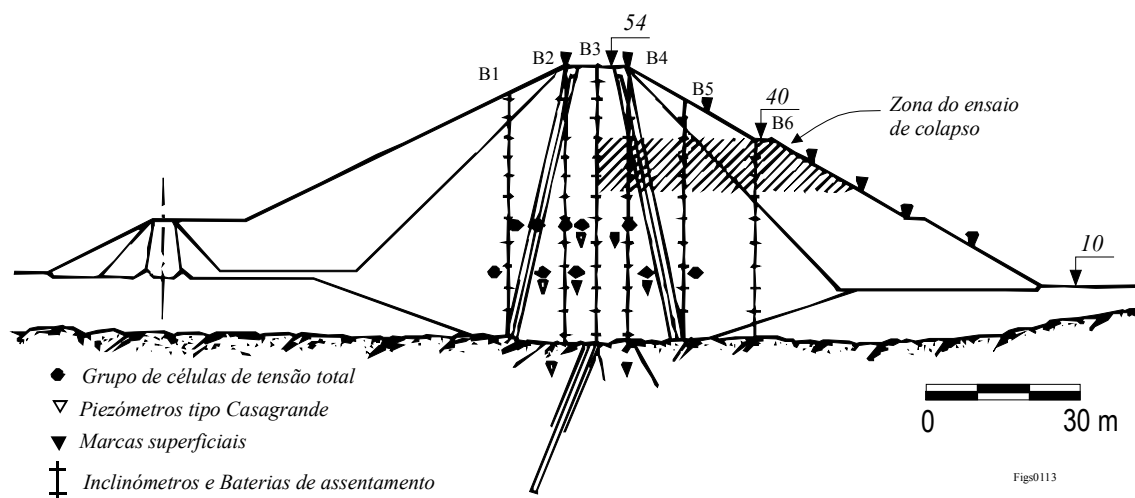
Perfil transversal da barragem de Beliche - Zona do ensaio de colapso
